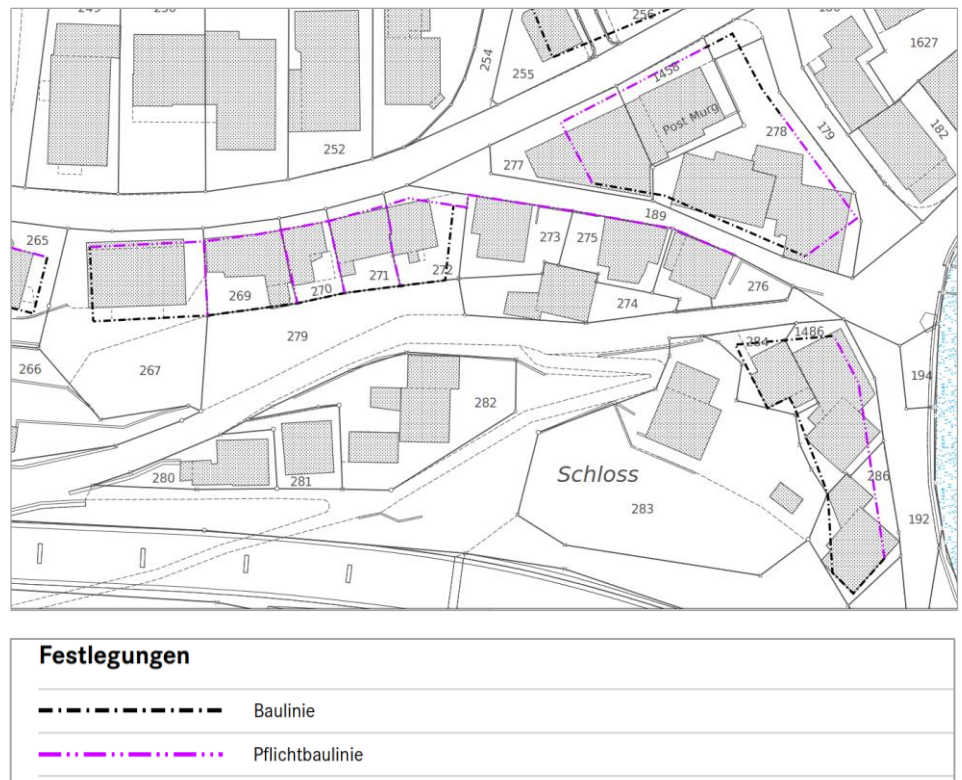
Ausschnitt Sondernutzungsplan "Baulinienplan Zentrum Murg" (Stand April 2026)
